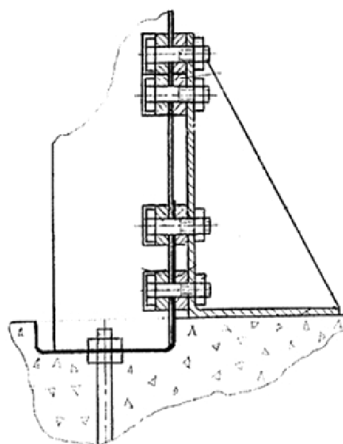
Крепление к фундаменту с помощью опорных кронштейнов
